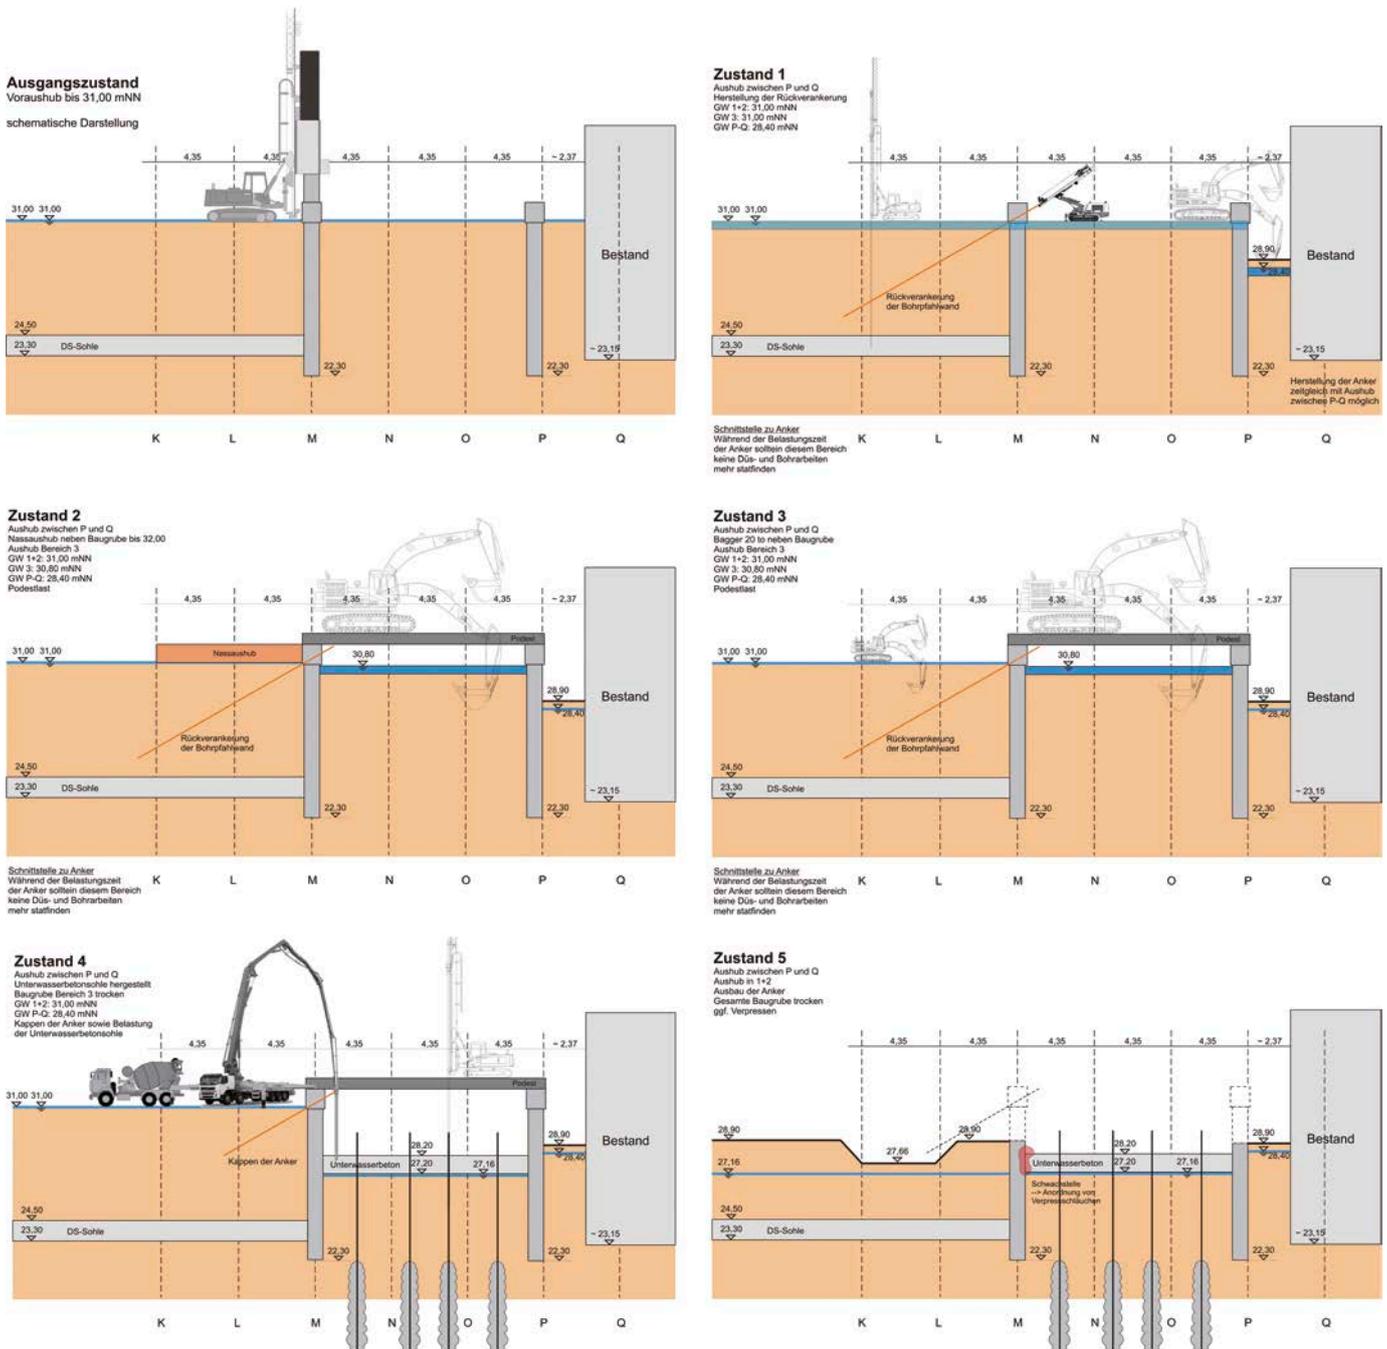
Gewählte und ausgeführte Variante: Verankerte UW-Betonsohle, umschließende Bohrpfahlwand, Unterwasserabbruch
